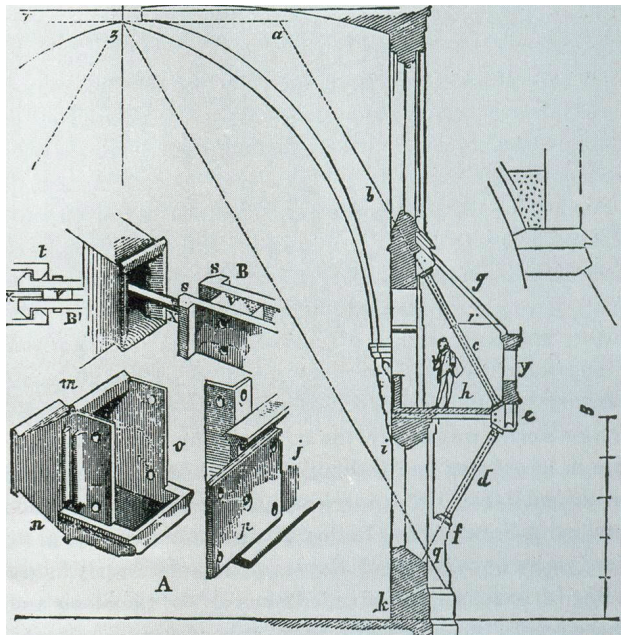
Desenho de Viollet-le-Duc de um pormenor estrutural.
